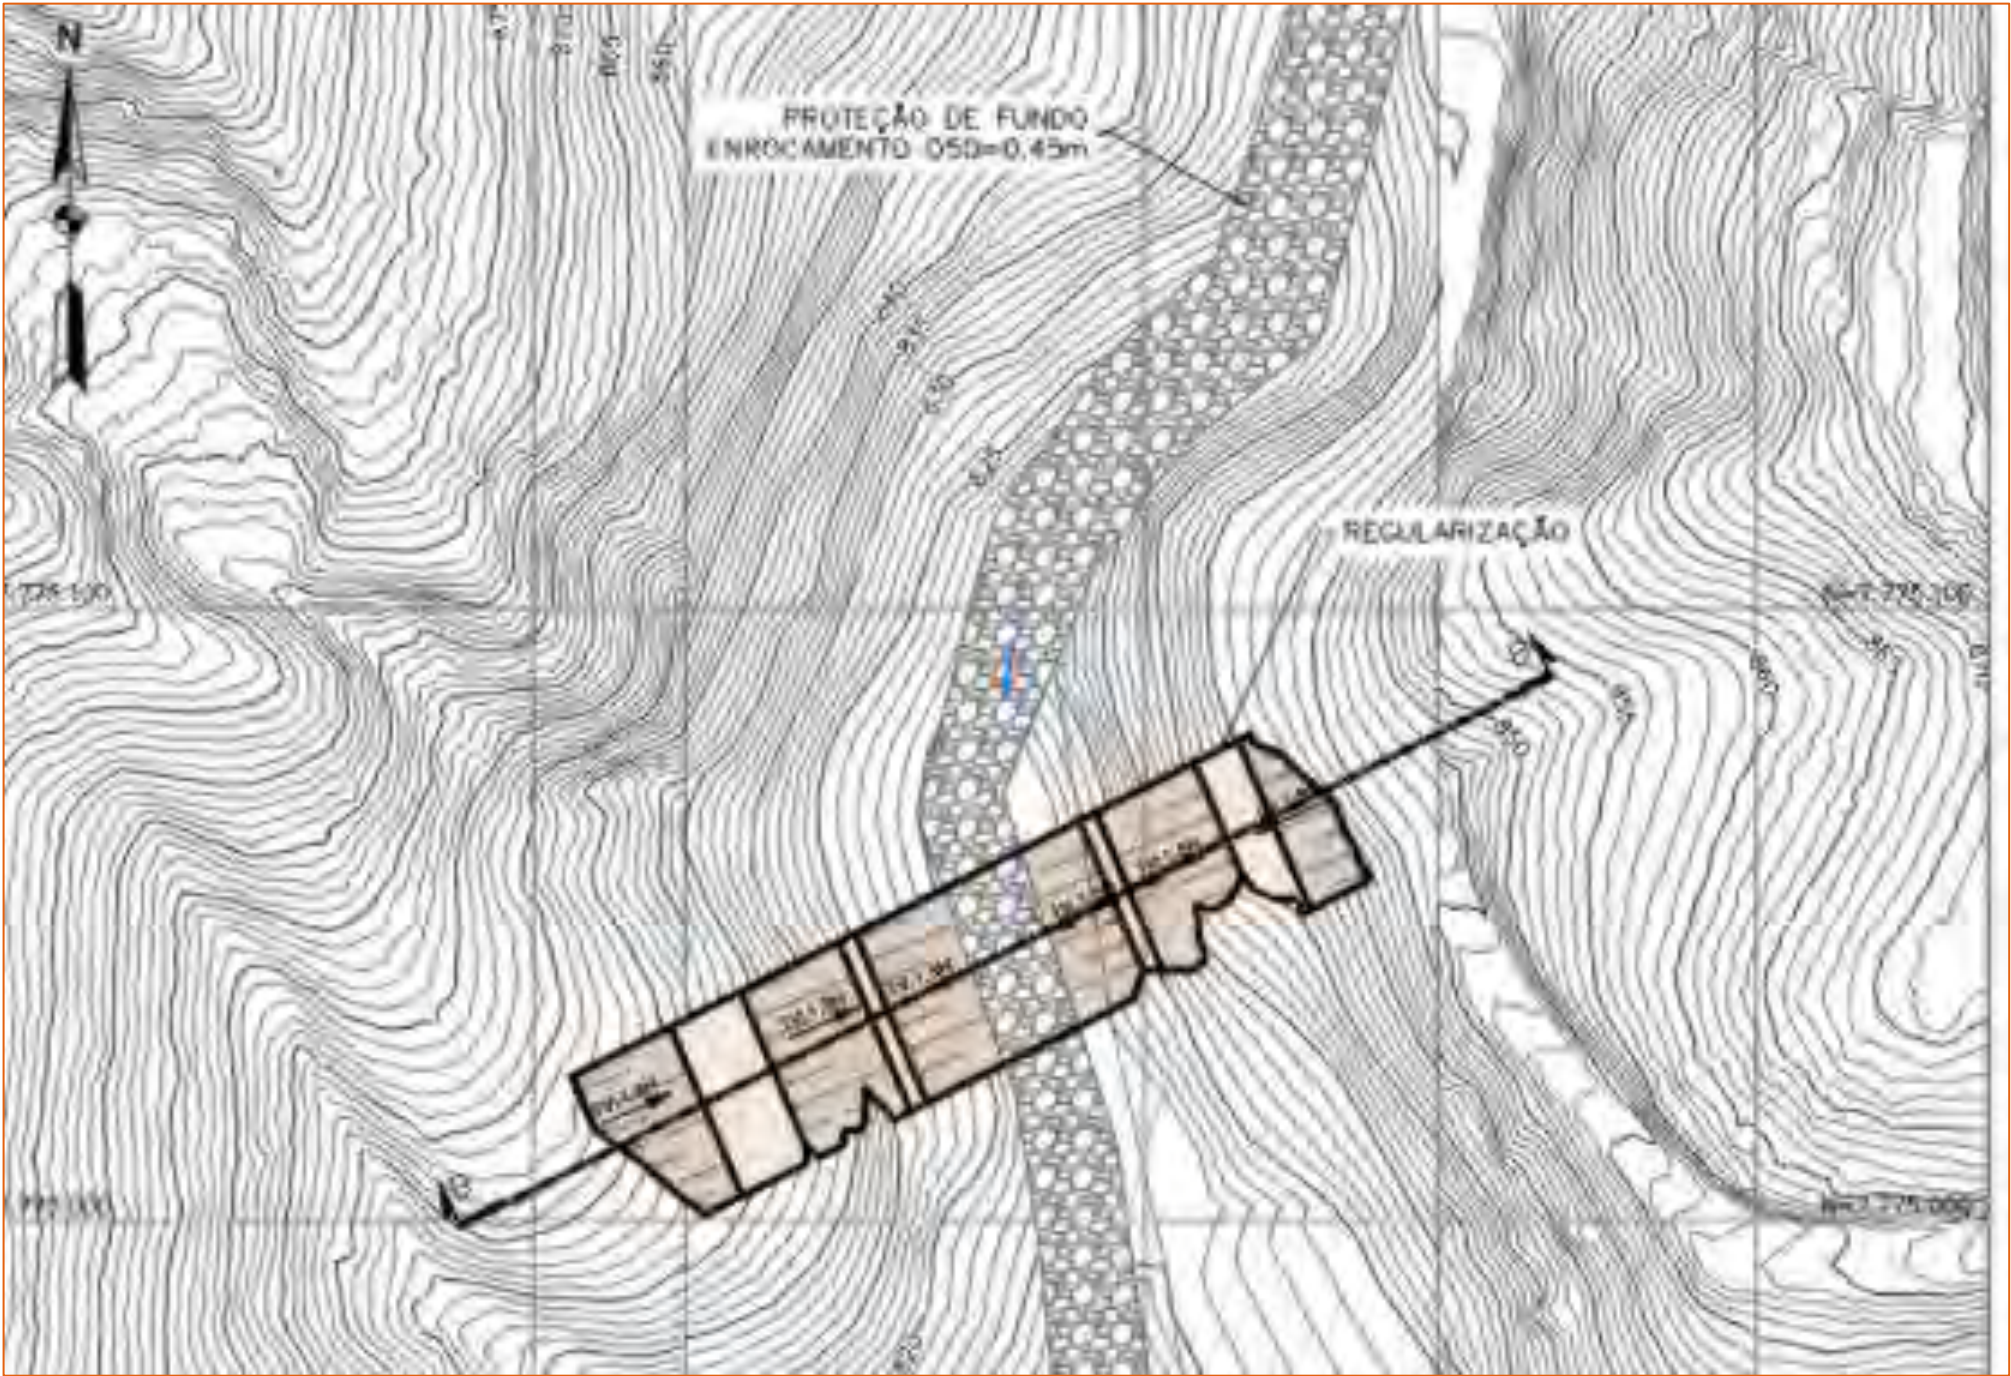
Planta de locação da Seção B-B para análises de estabilidade.
